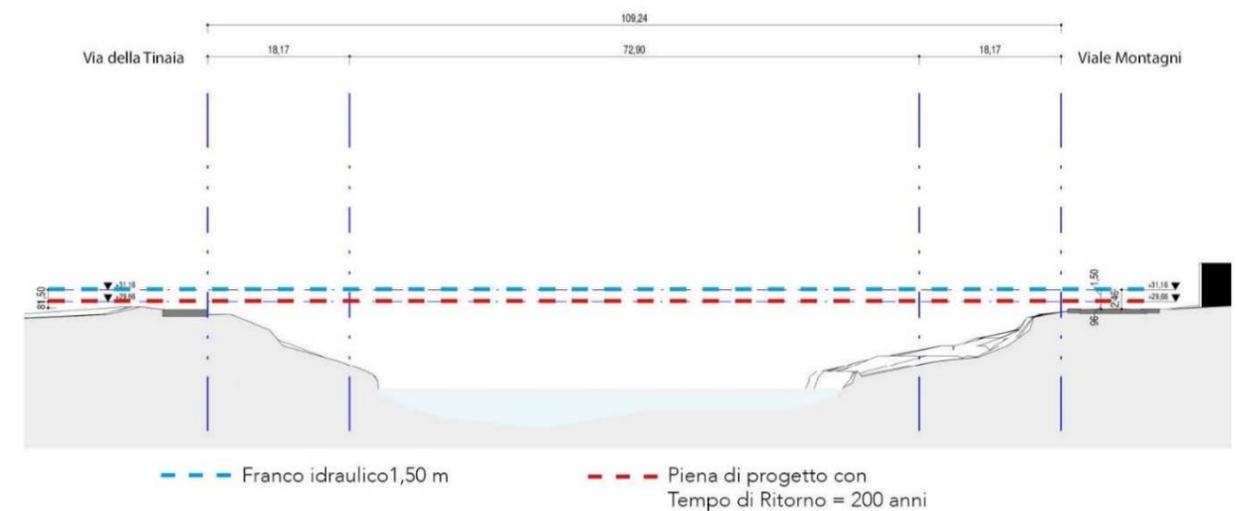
Sezione del fiume Arno in corrispondenza dell'attraversamento di progetto
